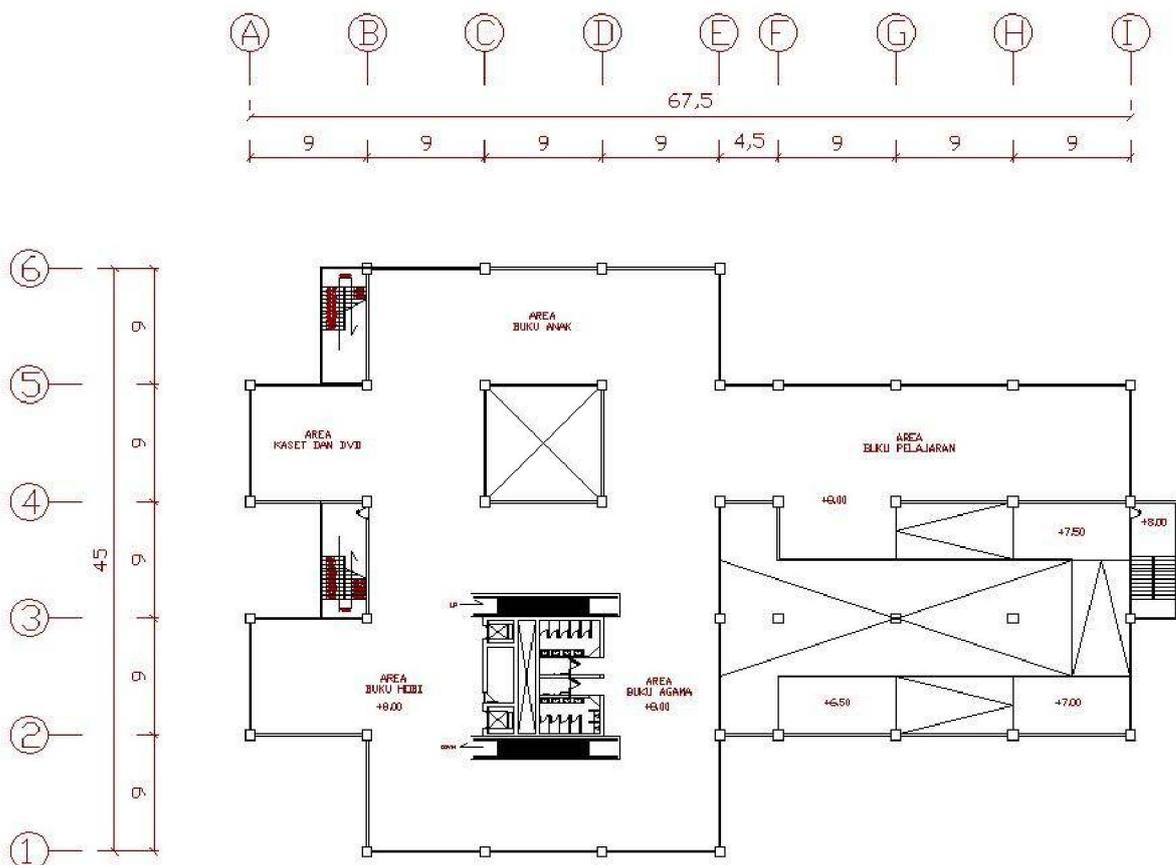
Denah lantai 2 plan Toko Buku Paling Lengkap
